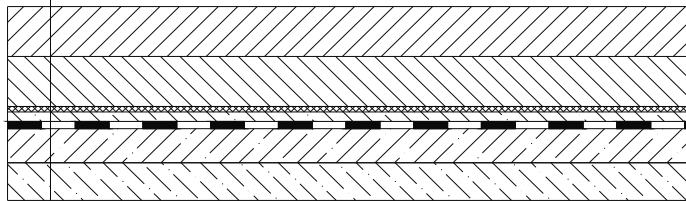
Конструкция дорожной одежды мостового полотна на мостах через реки Малая и Большая Каюковки (сталебетонные пролетные строения)
